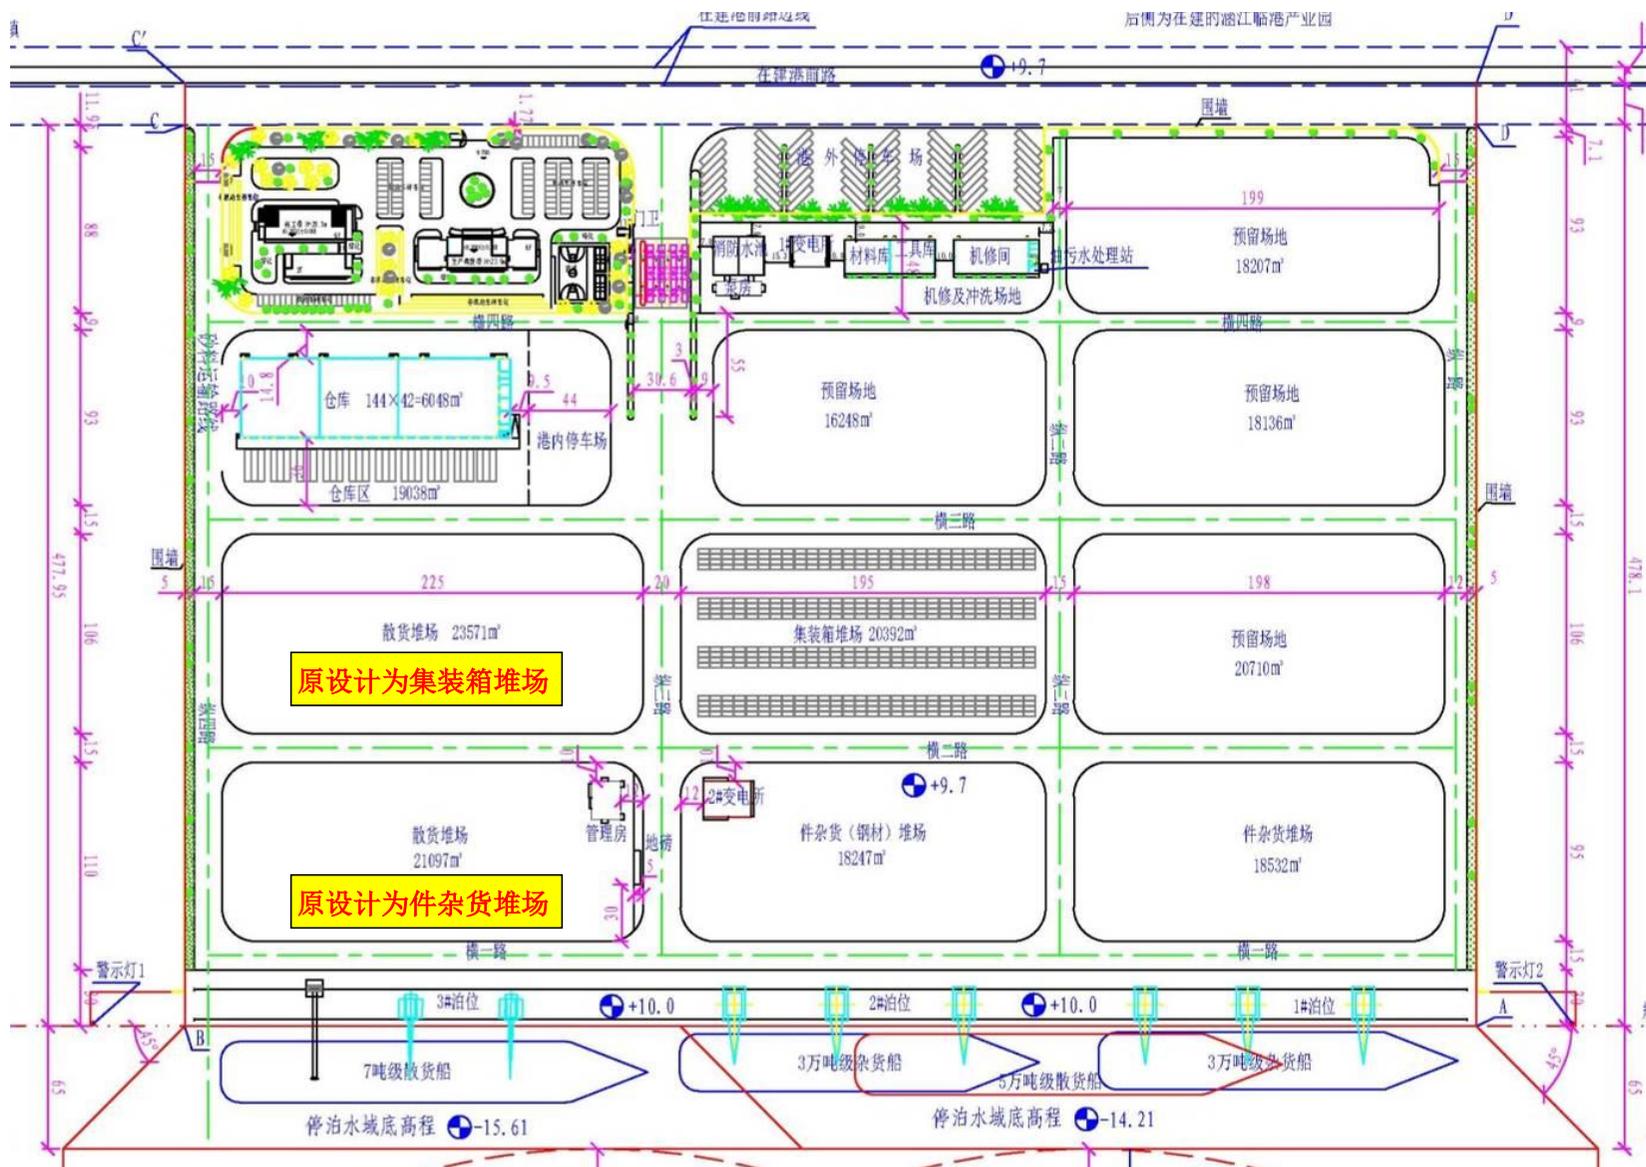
本次新增装卸工艺及货种后总平面布置图
